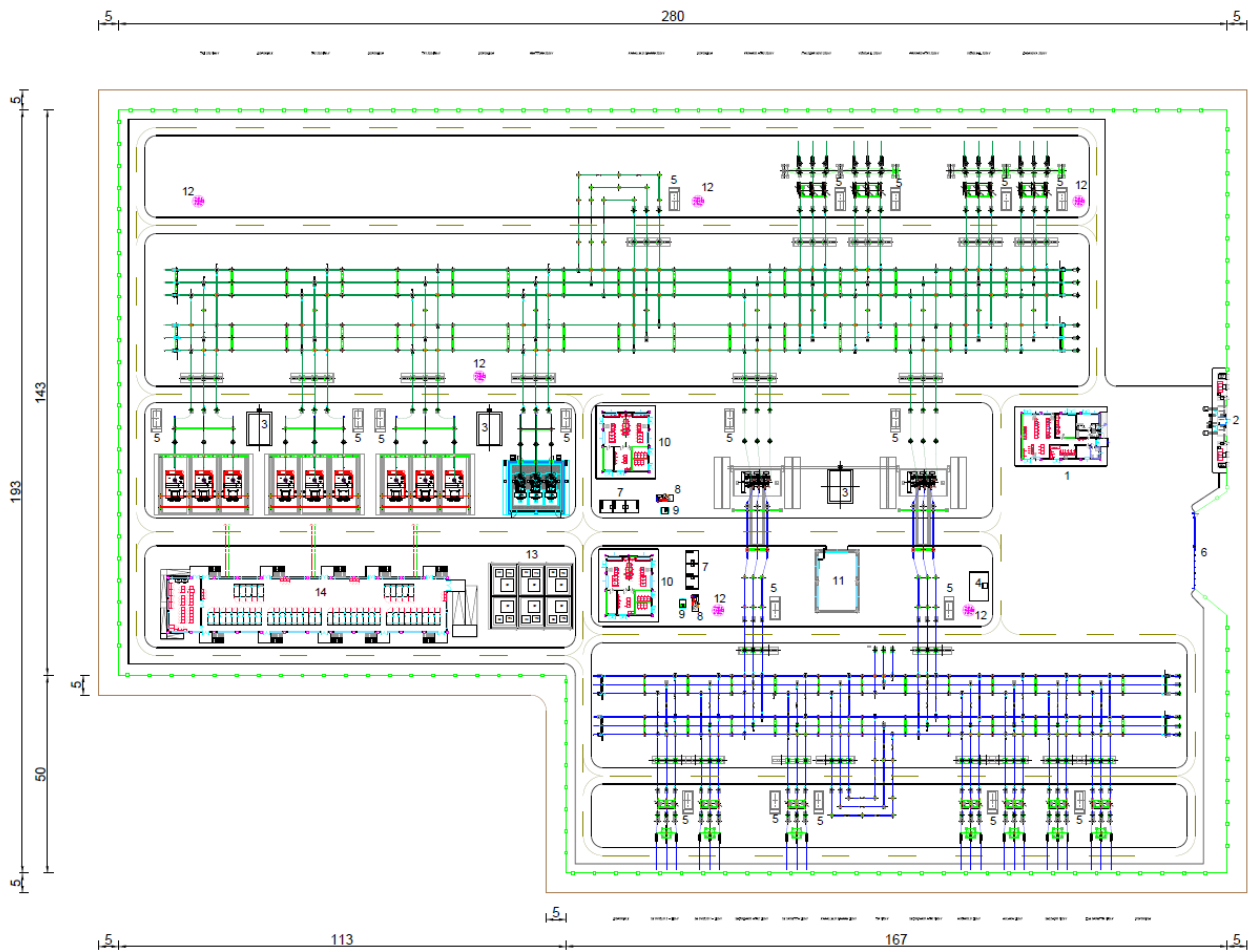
Planimetria Stazione Elettrica 220/132/36 kV
